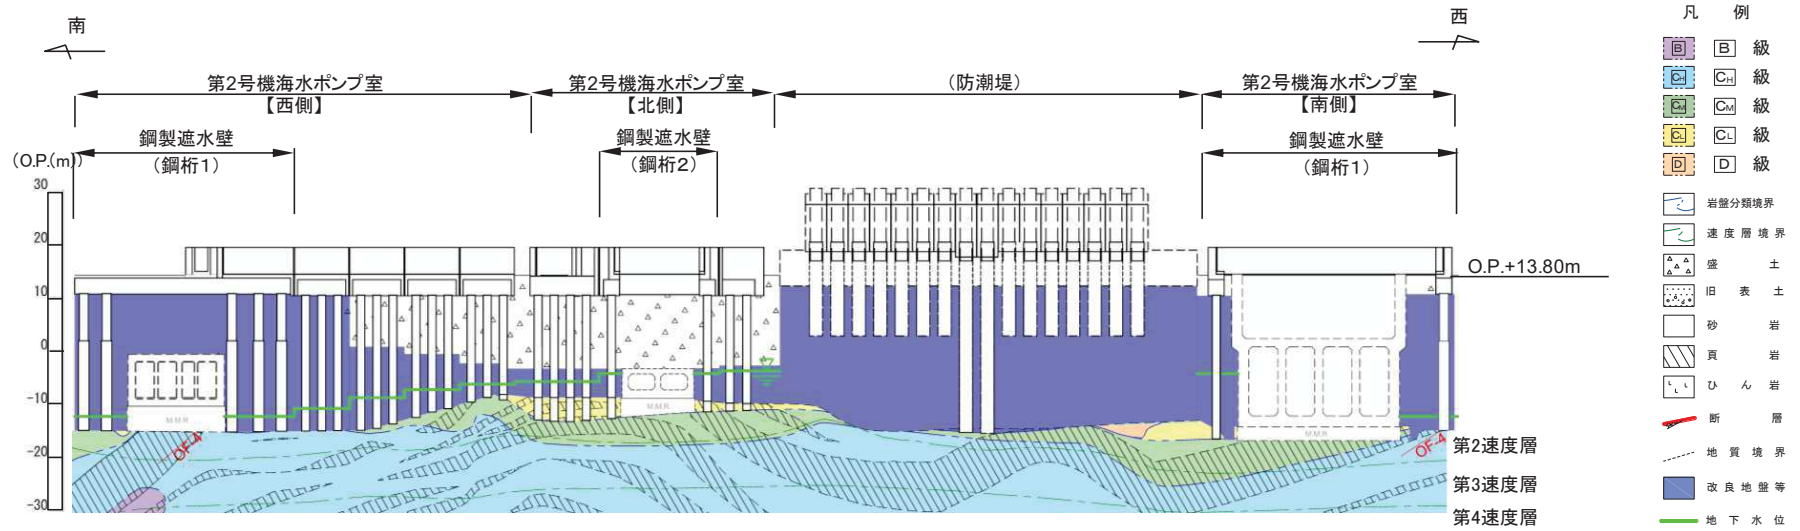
(1) 鋼製遮水壁（鋼桁）周辺の地質状況（第2号機海水ポンプ室）
